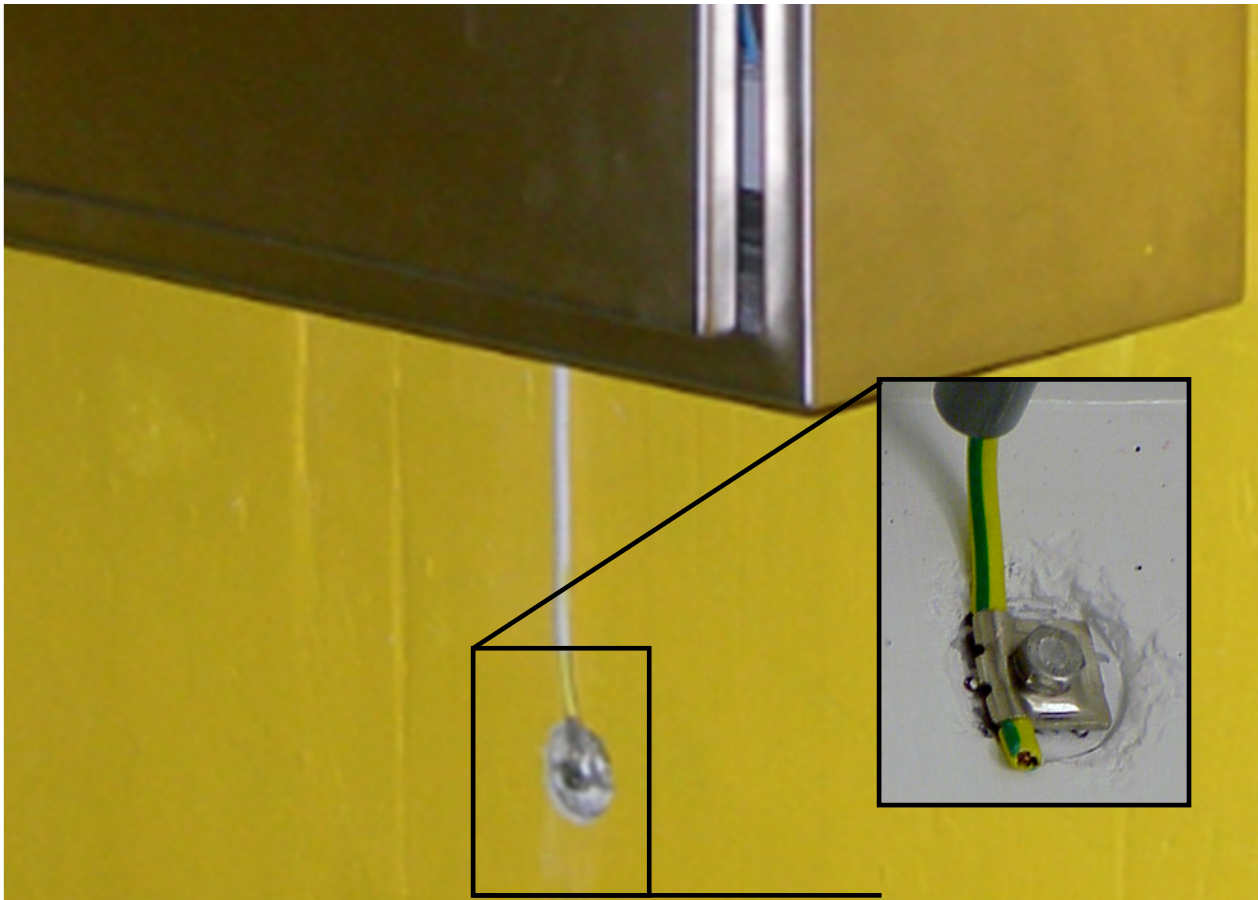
Installazione successiva del punto di connessione ZS per il collegamento equipotenziale di protezione
